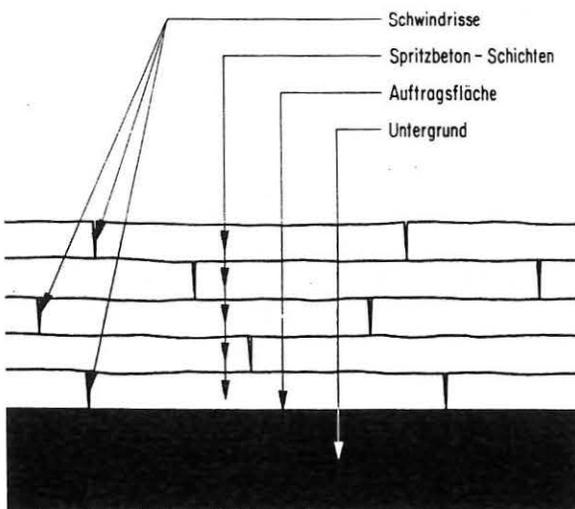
Schematisches Schwindrissebild des Spritzbetons bei fachgerechtem Schichtenaufbau /13/
